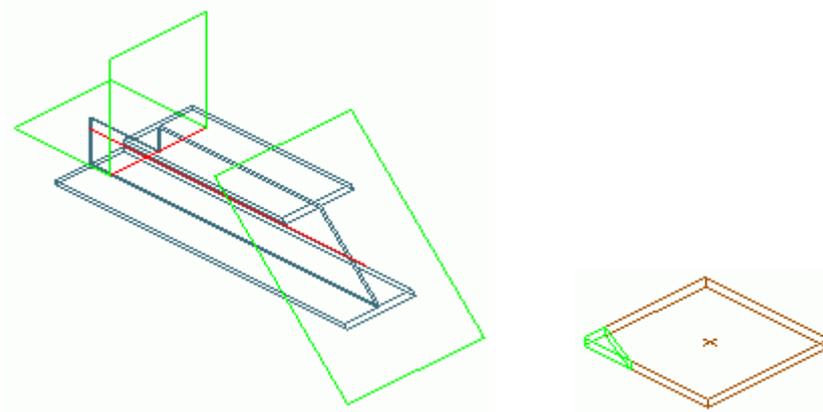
Grugeage d'une poutre, et chanfreinage d'une tôle
